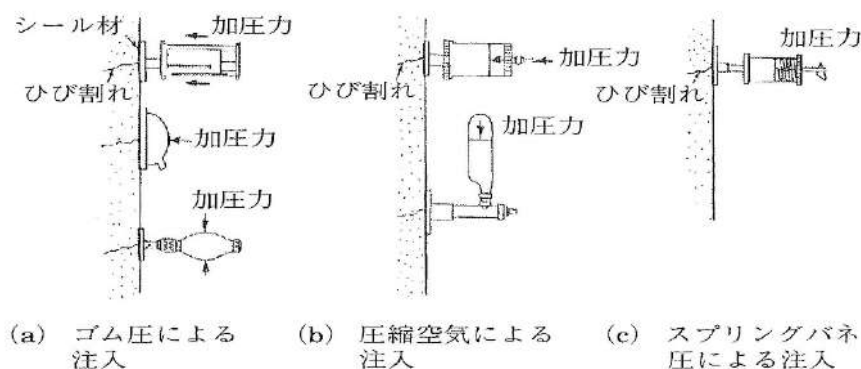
ひび割れ注入工法の施工例（低圧注入）
